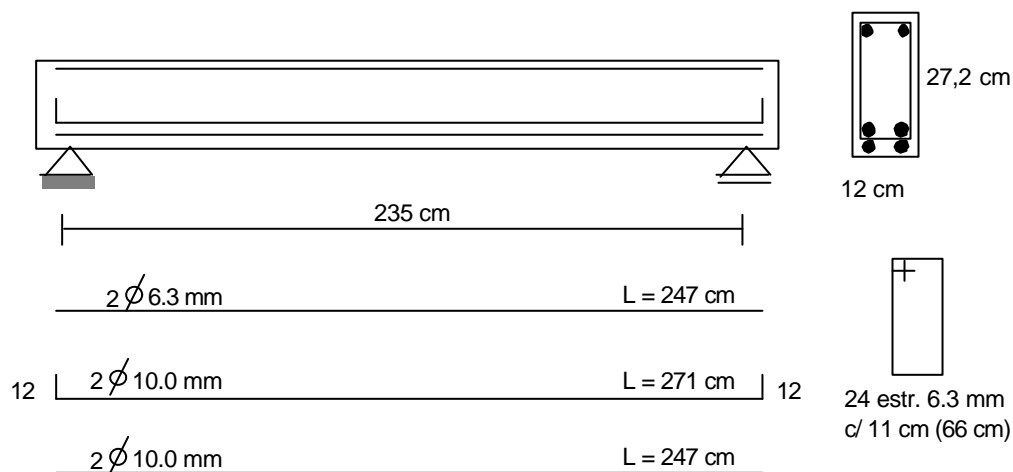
Armadura da viga reforçada com argamassa aditivada
